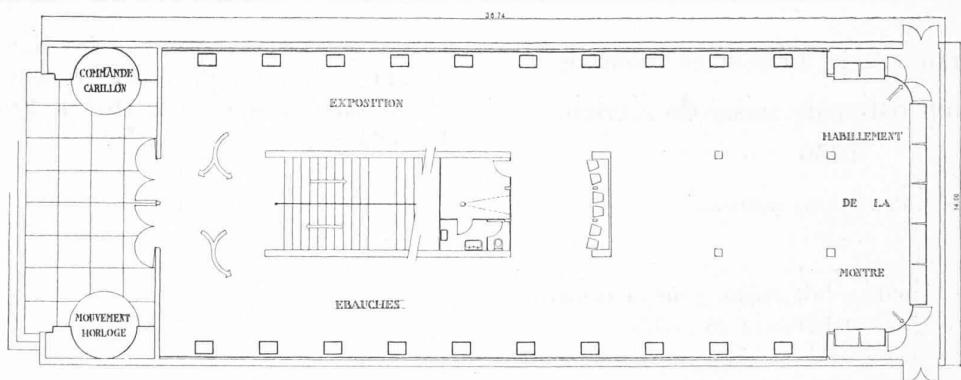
Le pavillon de l'horlogerie. Rez-de-chaussée.
